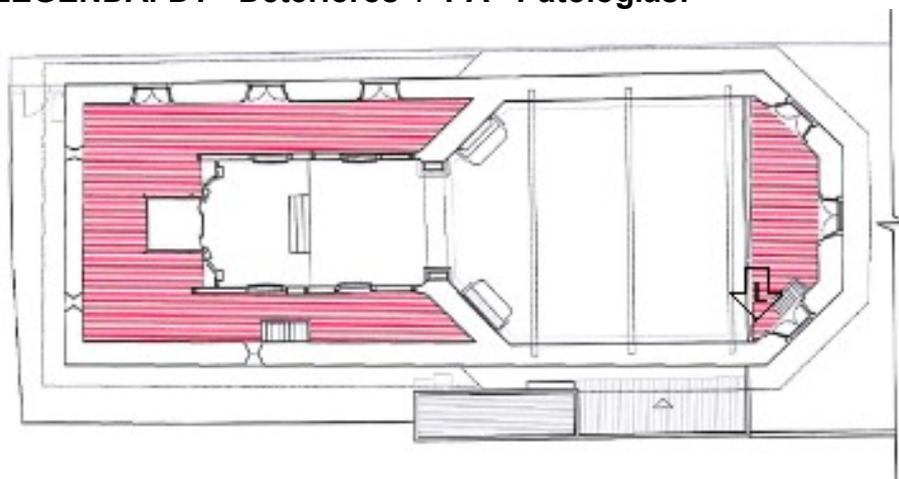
Vista L- Canto coro junto à escada de acesso ao pav. inferior – Planta pavimento superior - Capela Sem escada.
